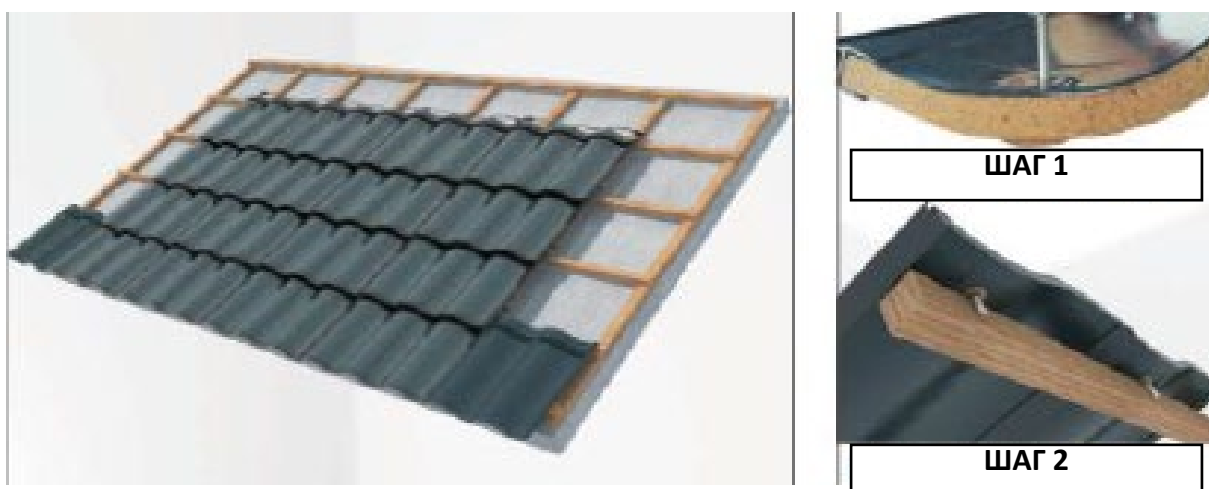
Установка солнечной черепицы на бетонной крыше
